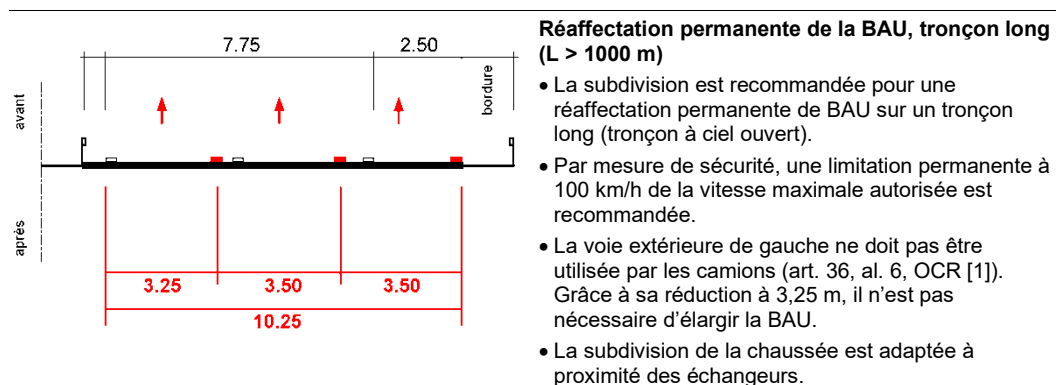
Subdivision de la chaussée en cas de réaffectation permanente de la BAU sur un tronçon long.
